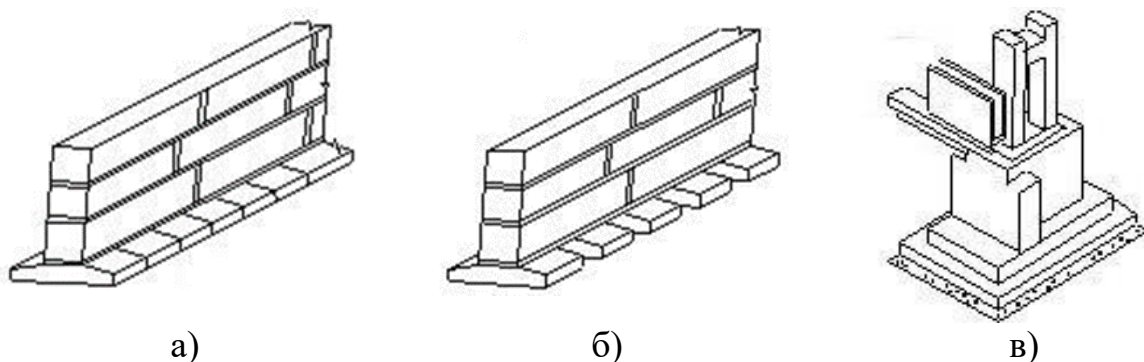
Типи жорстких фундаментів мілкого закладання:
